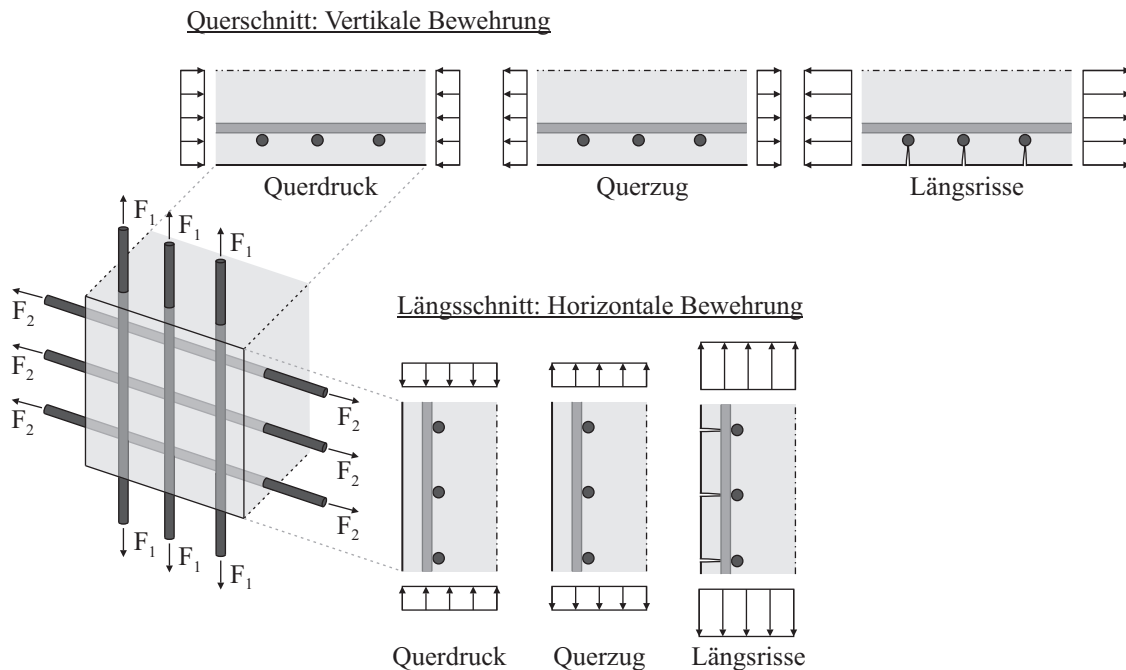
Ausschnitt eines Stahlbetonbauteils mit orthogonalem Bewehrungsnetz
